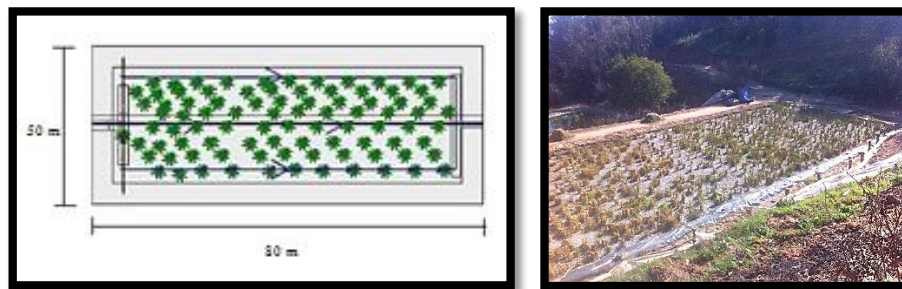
Vista en planta humedal proyectado y post-construcción (Fuente: Colombo, 2015).-
